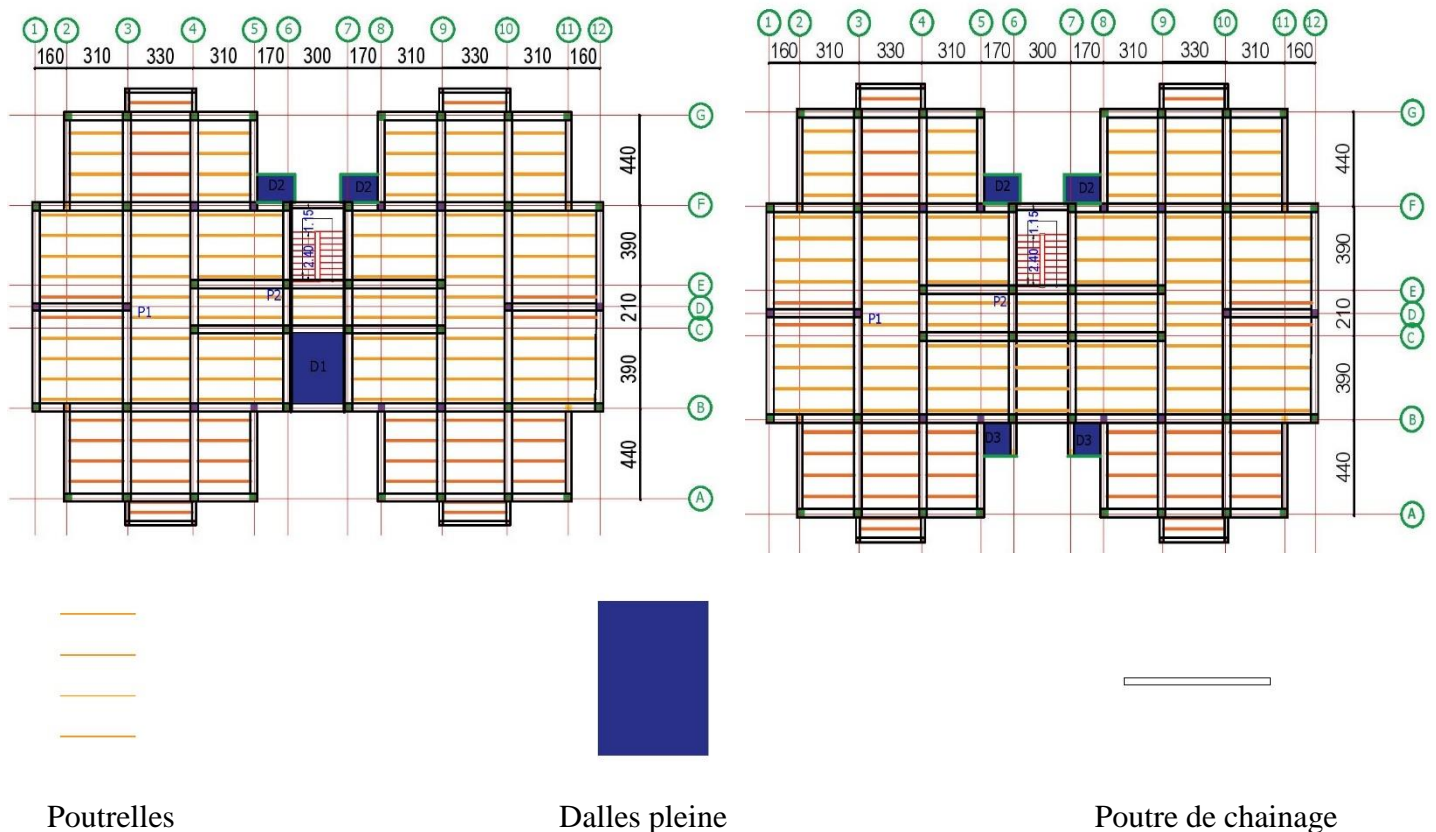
schéma de disposition des poutrelles et dalles pleines étage courant et RDC
